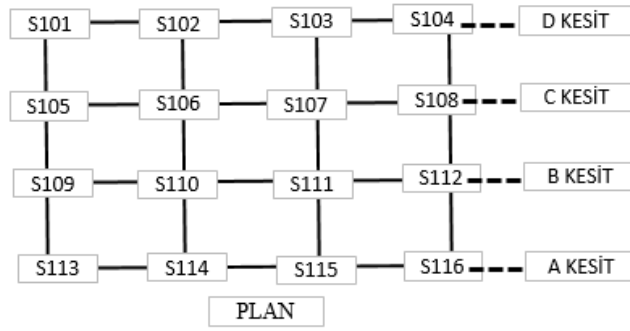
Yedi Katlı bina kiriş planı ve numaralandırılması
